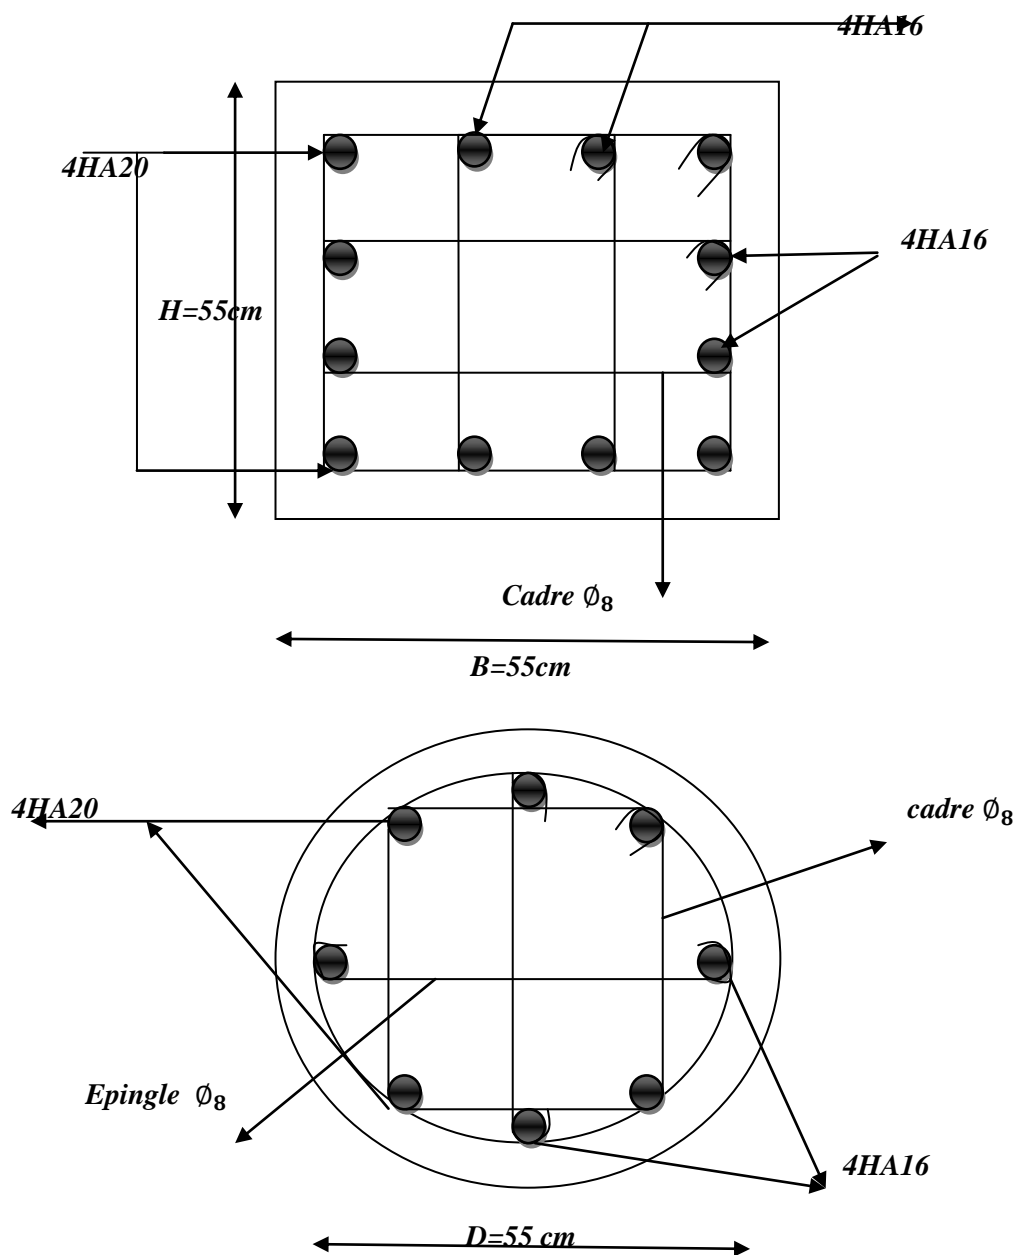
Schémas de ferrailage de poteaux rectangulaire et circulaire 55 × 55
